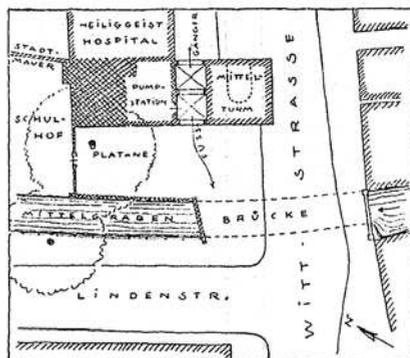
Lageplan der Bebauung am Mittel-turm um 1930 (Repro im Fotoarchiv des Uckermärkischen Geschichtsvereins)
